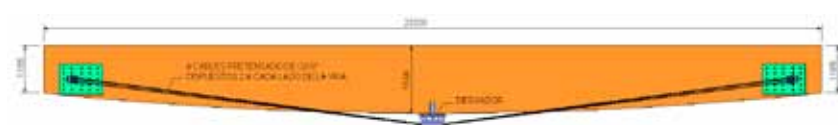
Esquema de refuerzo por cables de tesado vigas laterales
